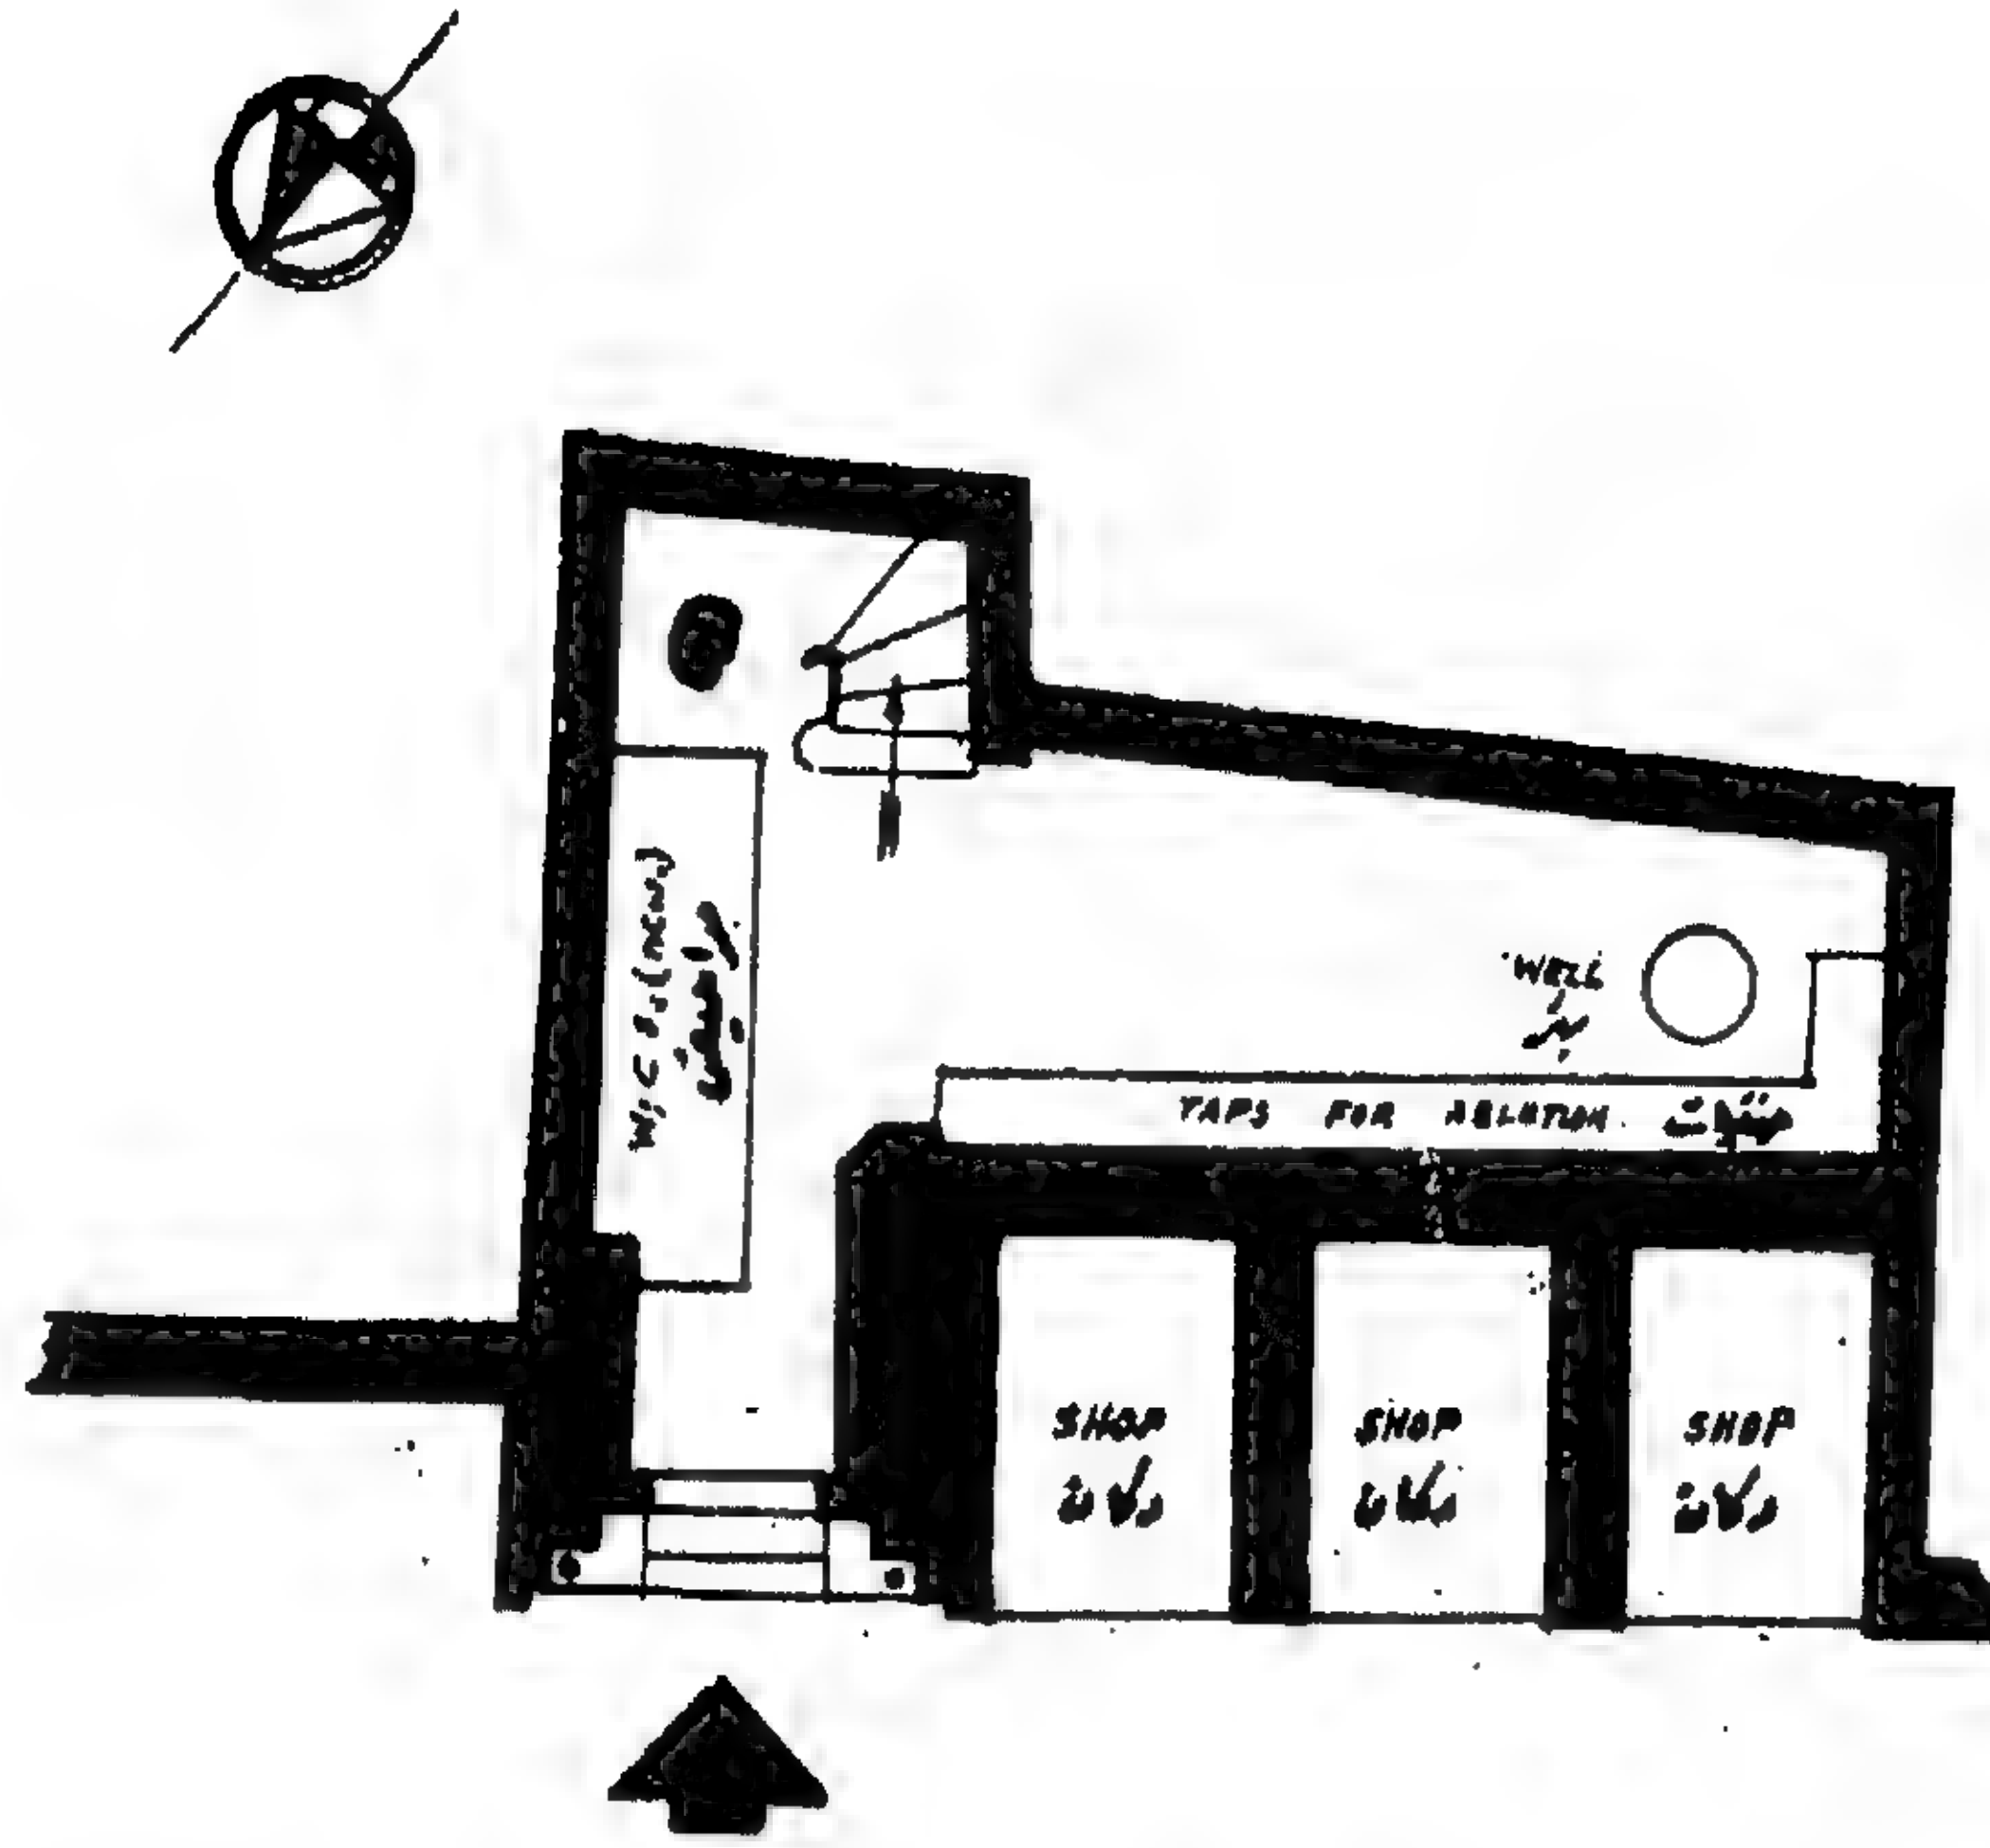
مسقط أفقي للدور الأول بمسجد الشوائبية بالموسكى.
